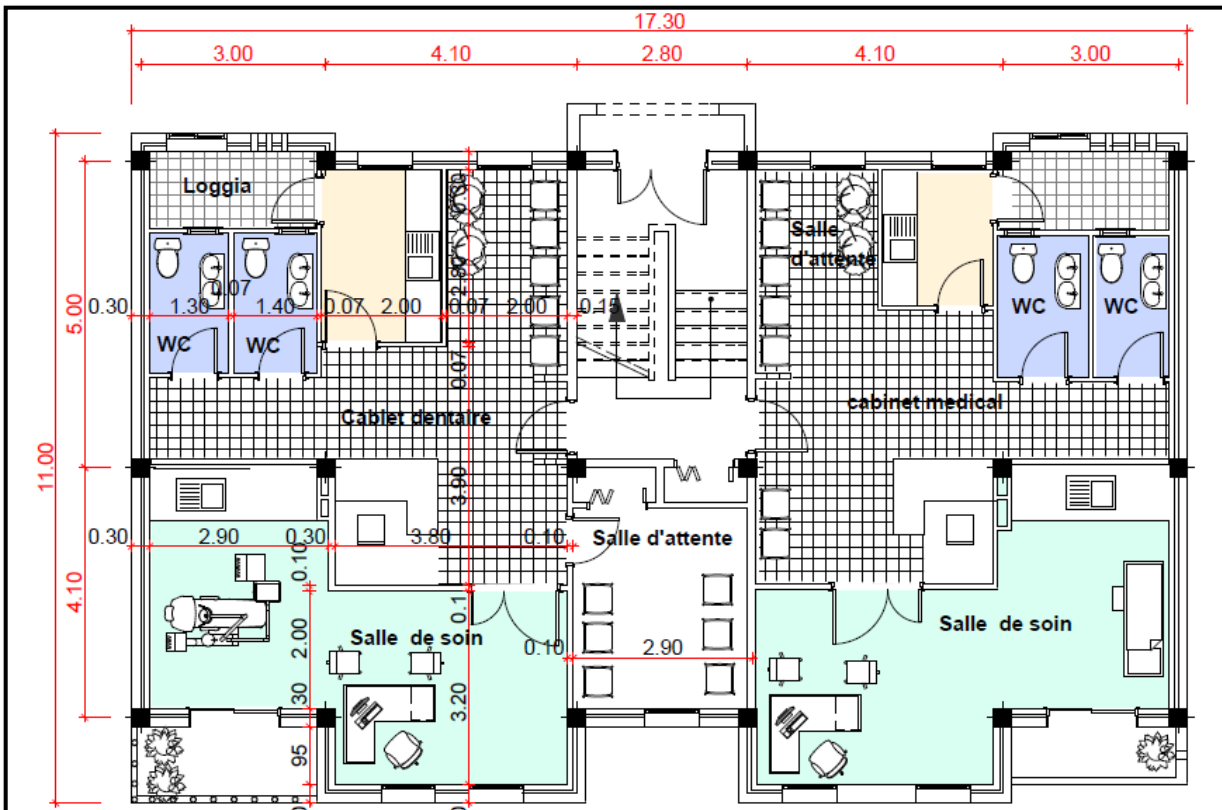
plan de RDC du bâtiment des services après la requalification, ECH 1/100. Source Auteur 2020
